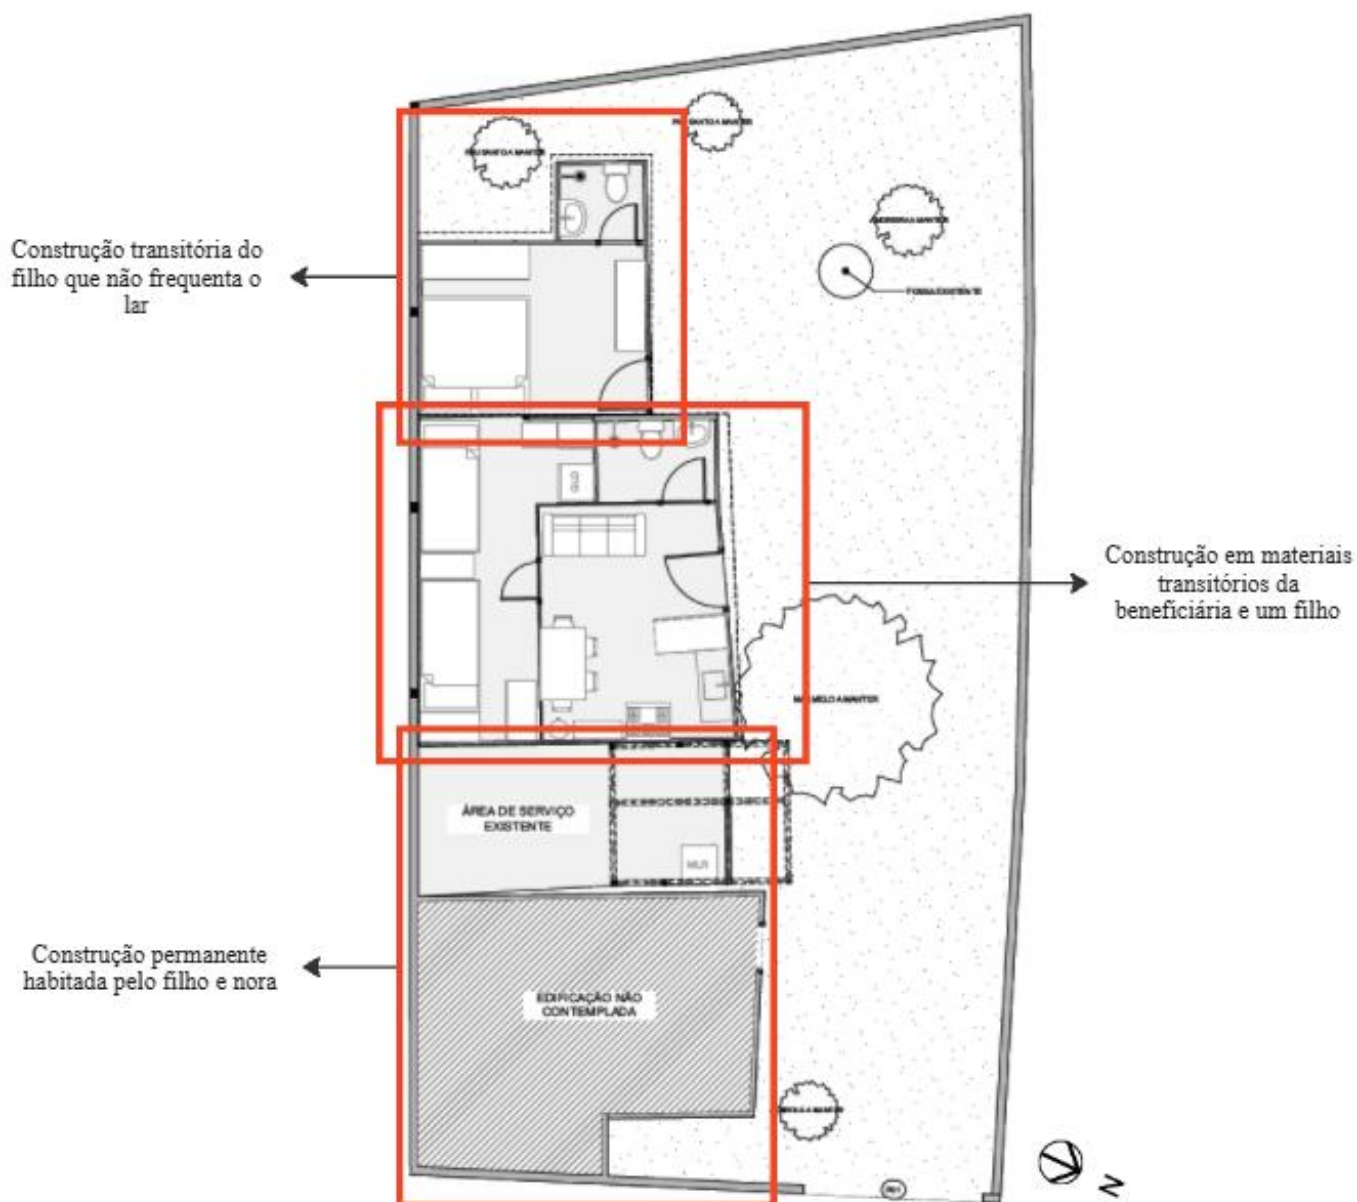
Planta de levantamento das edificações preexistentes no lote da ATNH-1
